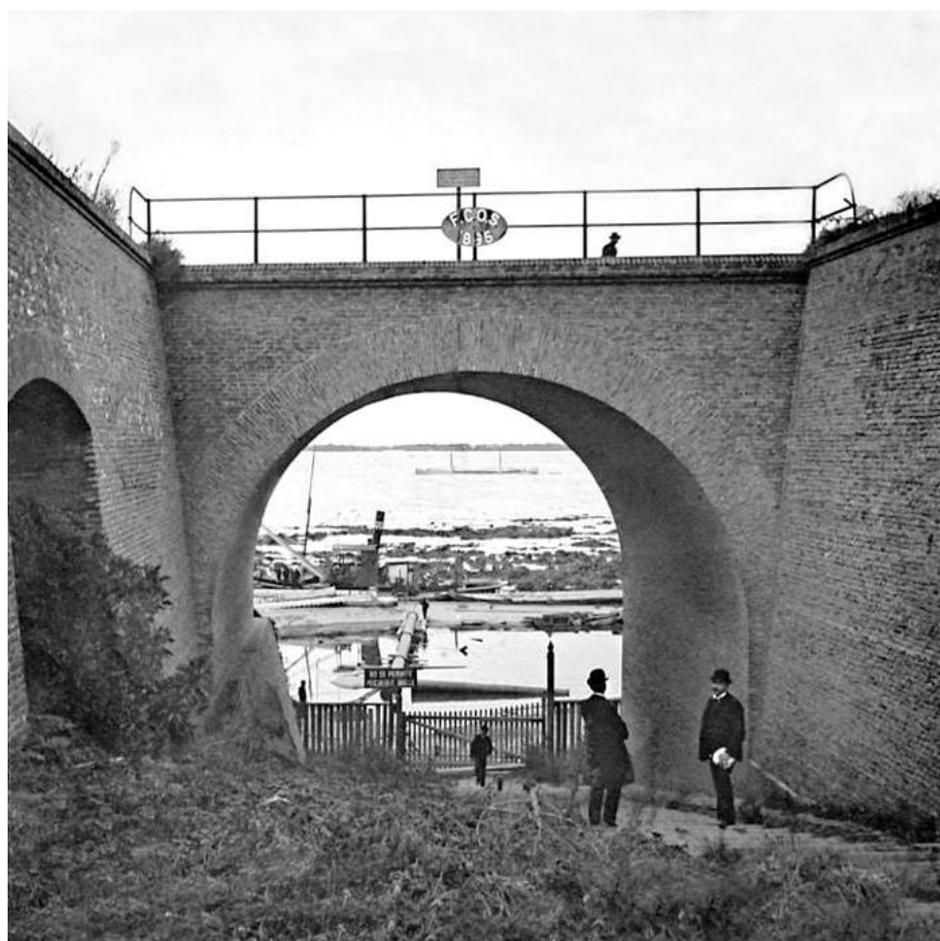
Muelle Casado. Fuente: Foto Archivo. Museo Nacional Ferroviario. Circa 1888.
